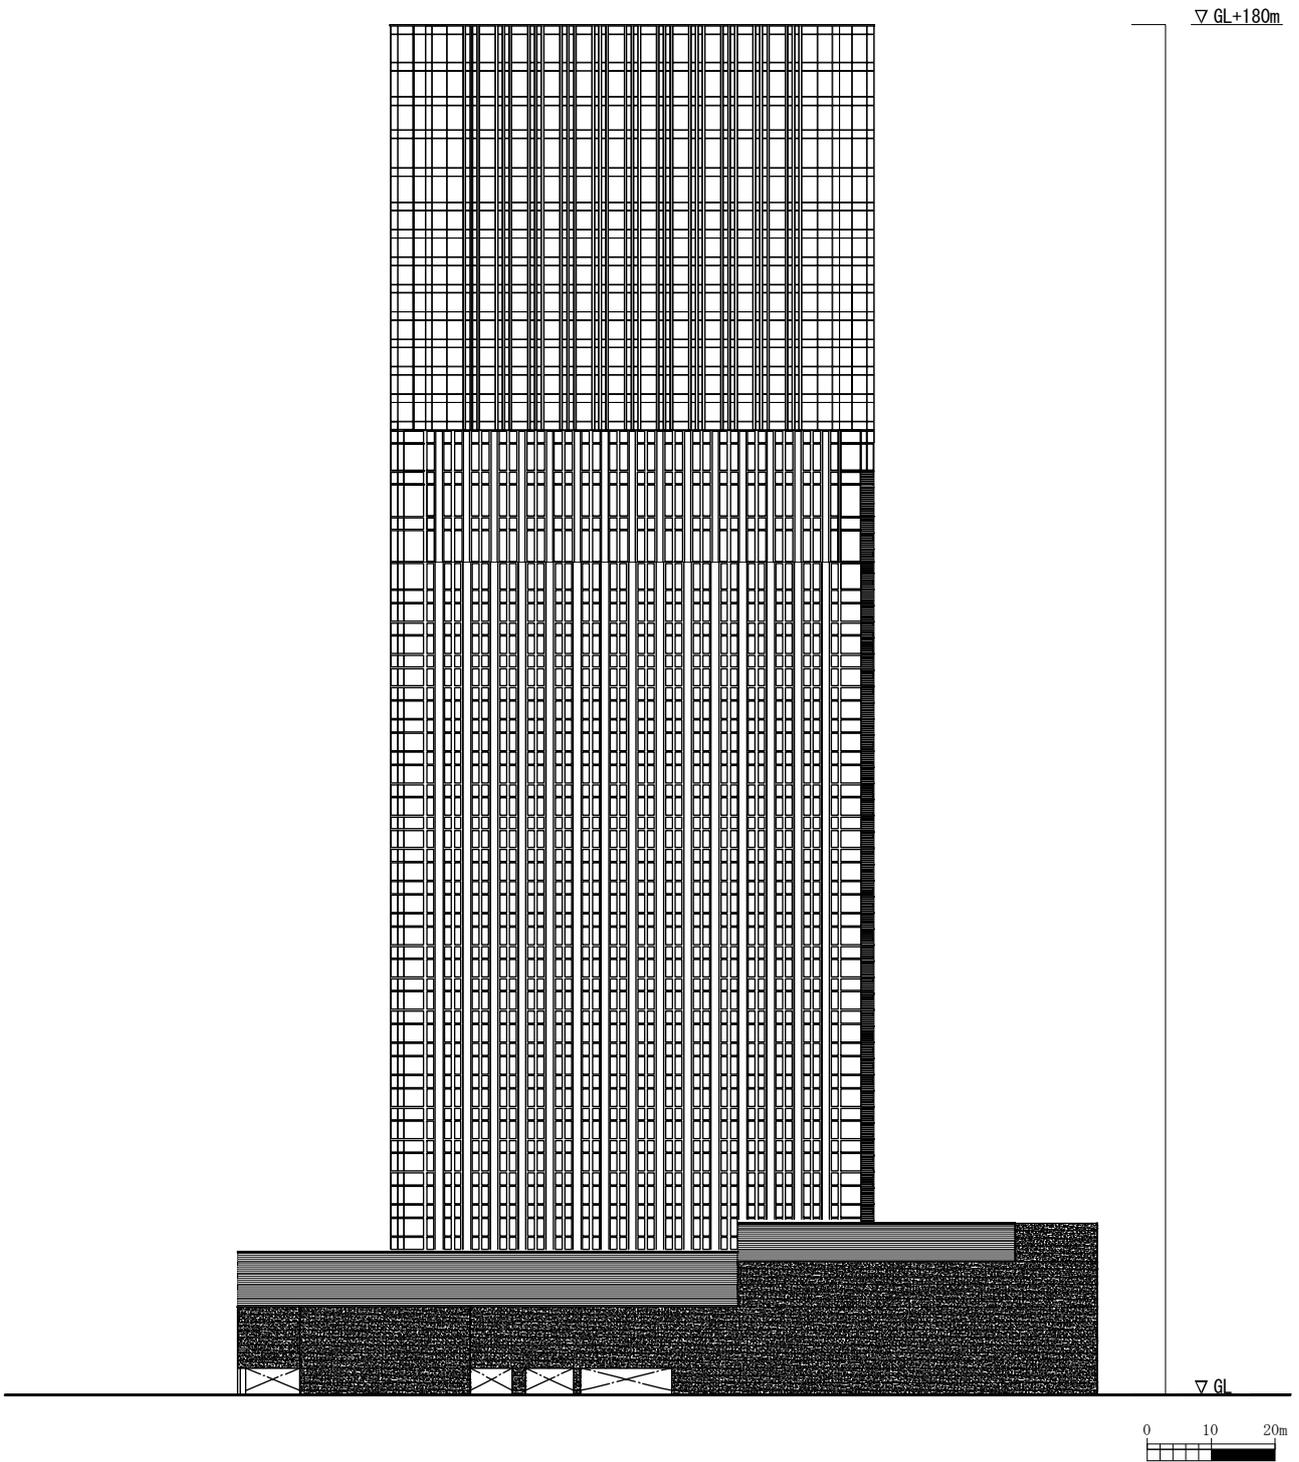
(4) 計画建築物立面図 (西側) (評価書(計画))
